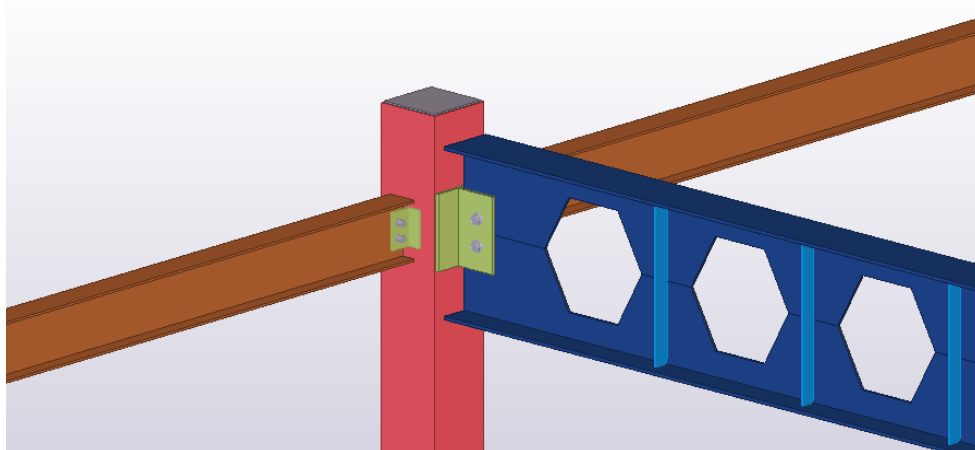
Узел крепления перфорированной балки к колонне
